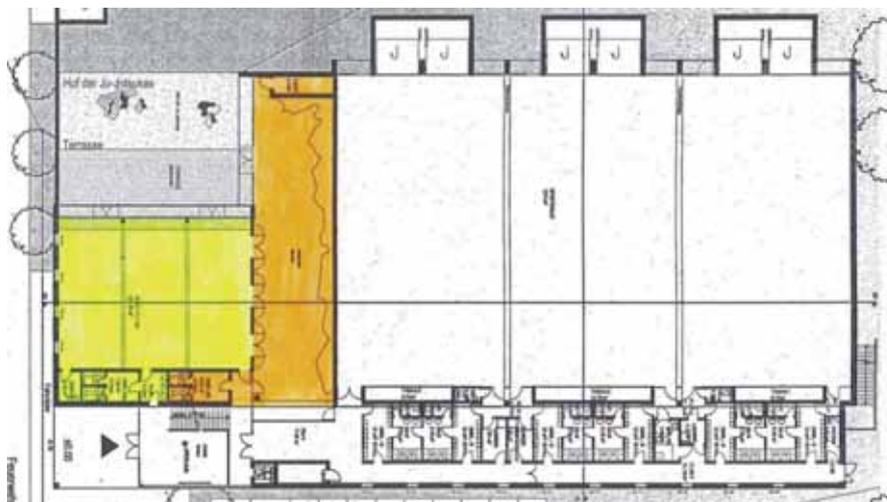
Grundriss Dreifeldturnhalle
